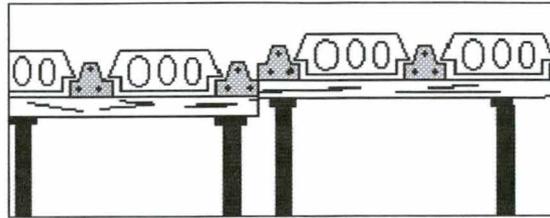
Detalhe do rebaixo na laje com vigota pré-moldada.
